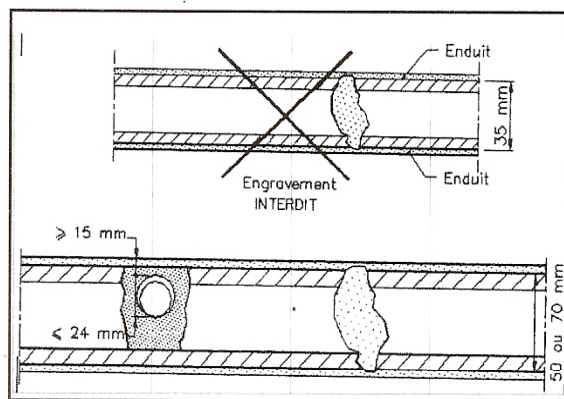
Engravement dans briques plâtrières-coupes horizontales
